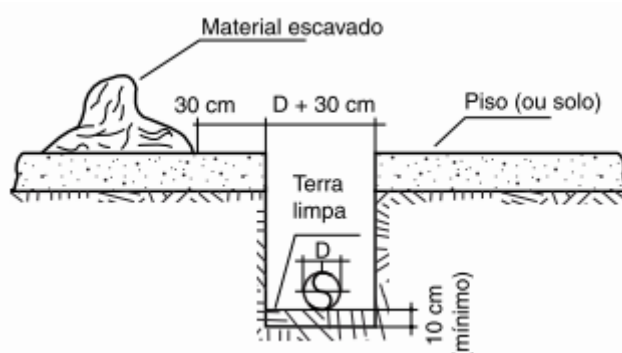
Instalação da tubulação enterrada. Fonte NBR 15.358
